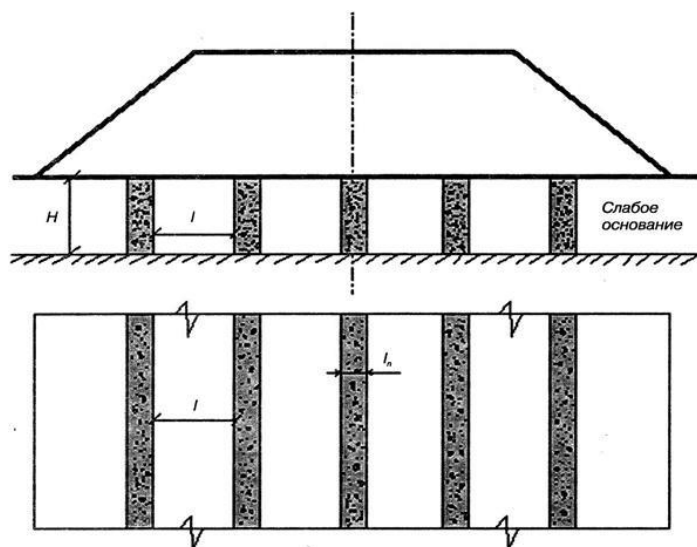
Схема земляного полотна на слабом основании с продольными прорезями
